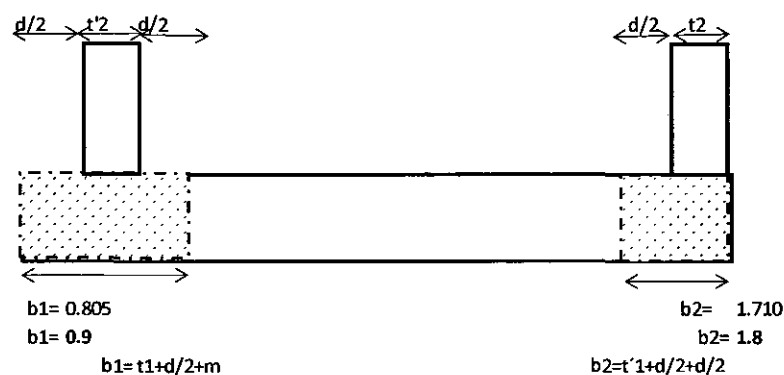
Dimensiones para el cálculo en la dirección transversal.
